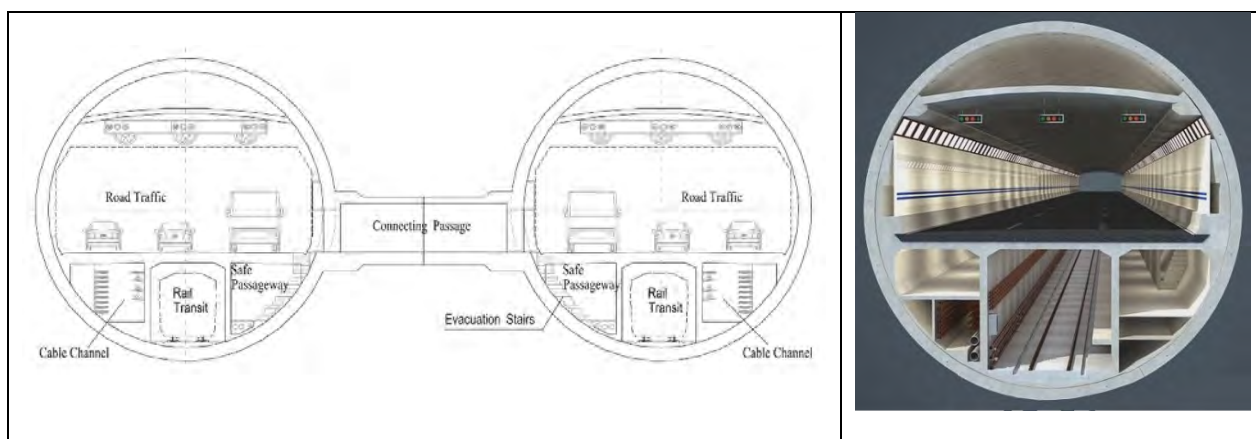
Sezione trasversale del tunnel subalveo Yangtze di Shanghai<sup>184</sup>
